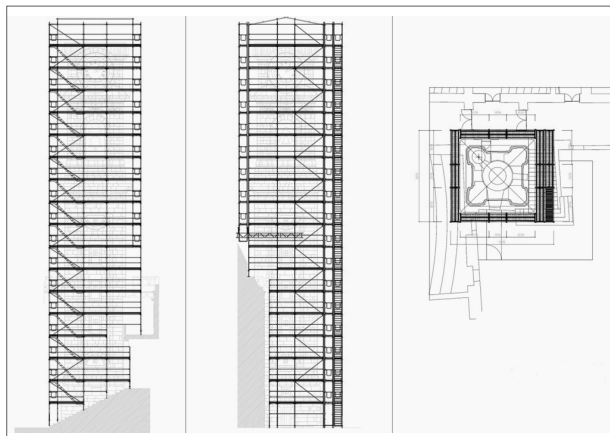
Alçados nascente e sul e planta de implantação pertencentes ao projecto do andaime
